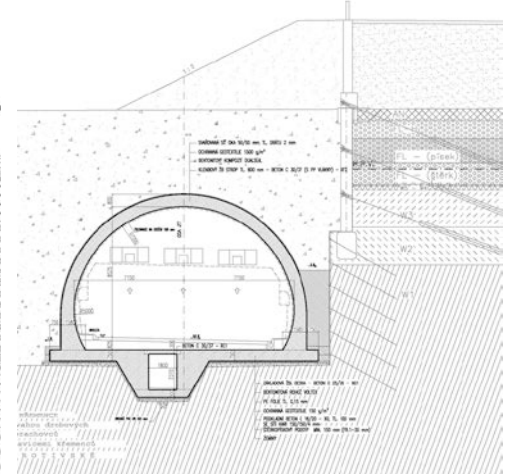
TCB – Sección transversal construida mediante excavación entre pantallas.
